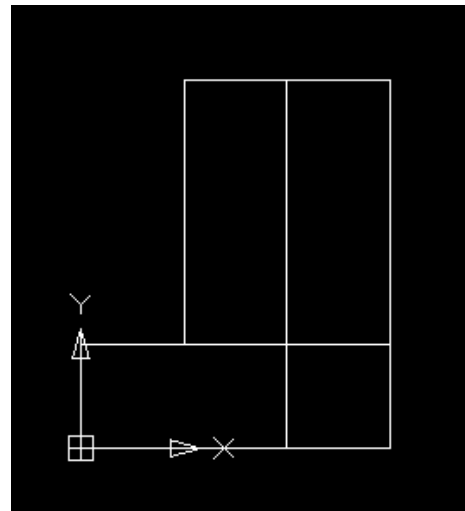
Planos en NanoCAD de la primera planta del edificio.
